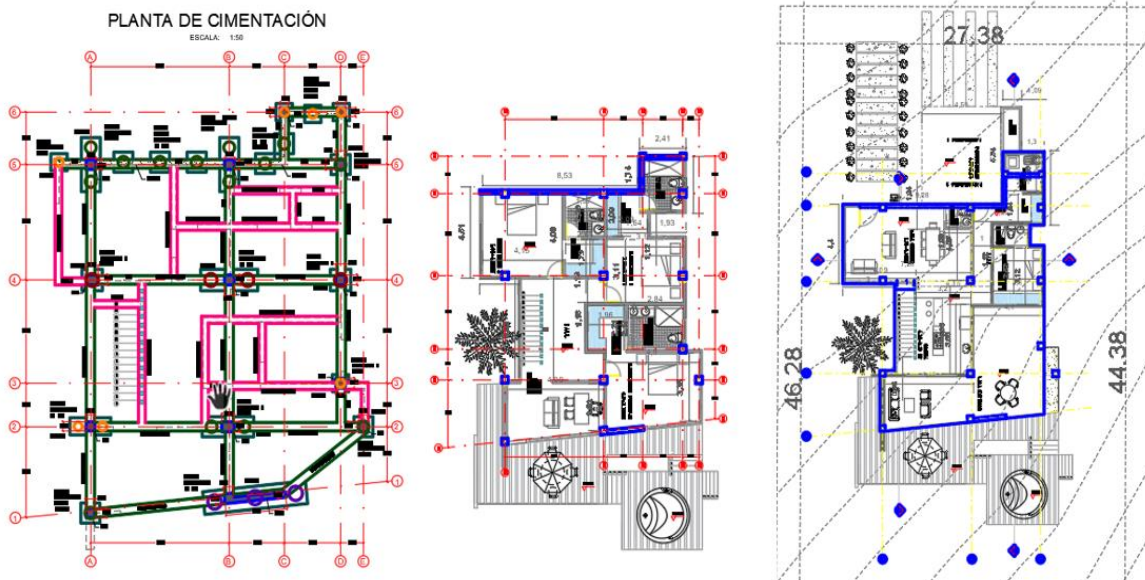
Cimentación y estructuras nivel 1 y 2 vivienda tipo Espejismo
